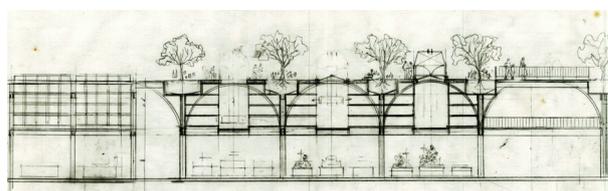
| “Corte cubista” do cemitério vertical do Campo Santo, projeto de Rebouças (1993-94)
